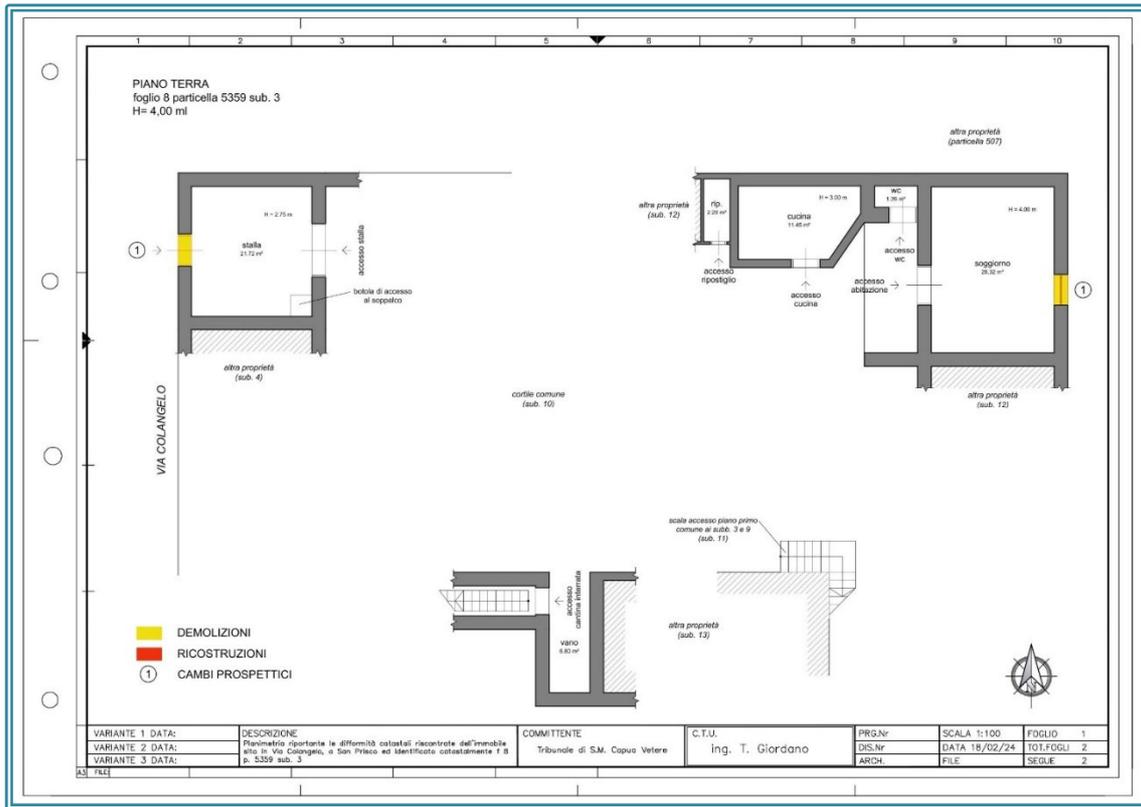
Schema difformità LOTTO 8 (Piano Terra)
